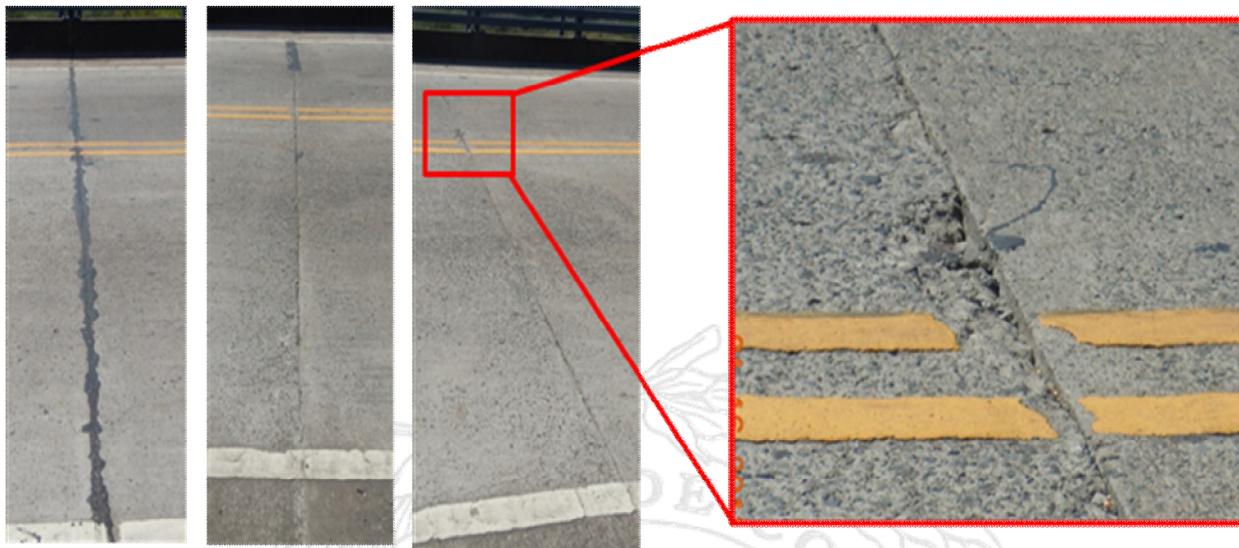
Juntas constructivas en la losa y detalle de fractura.
